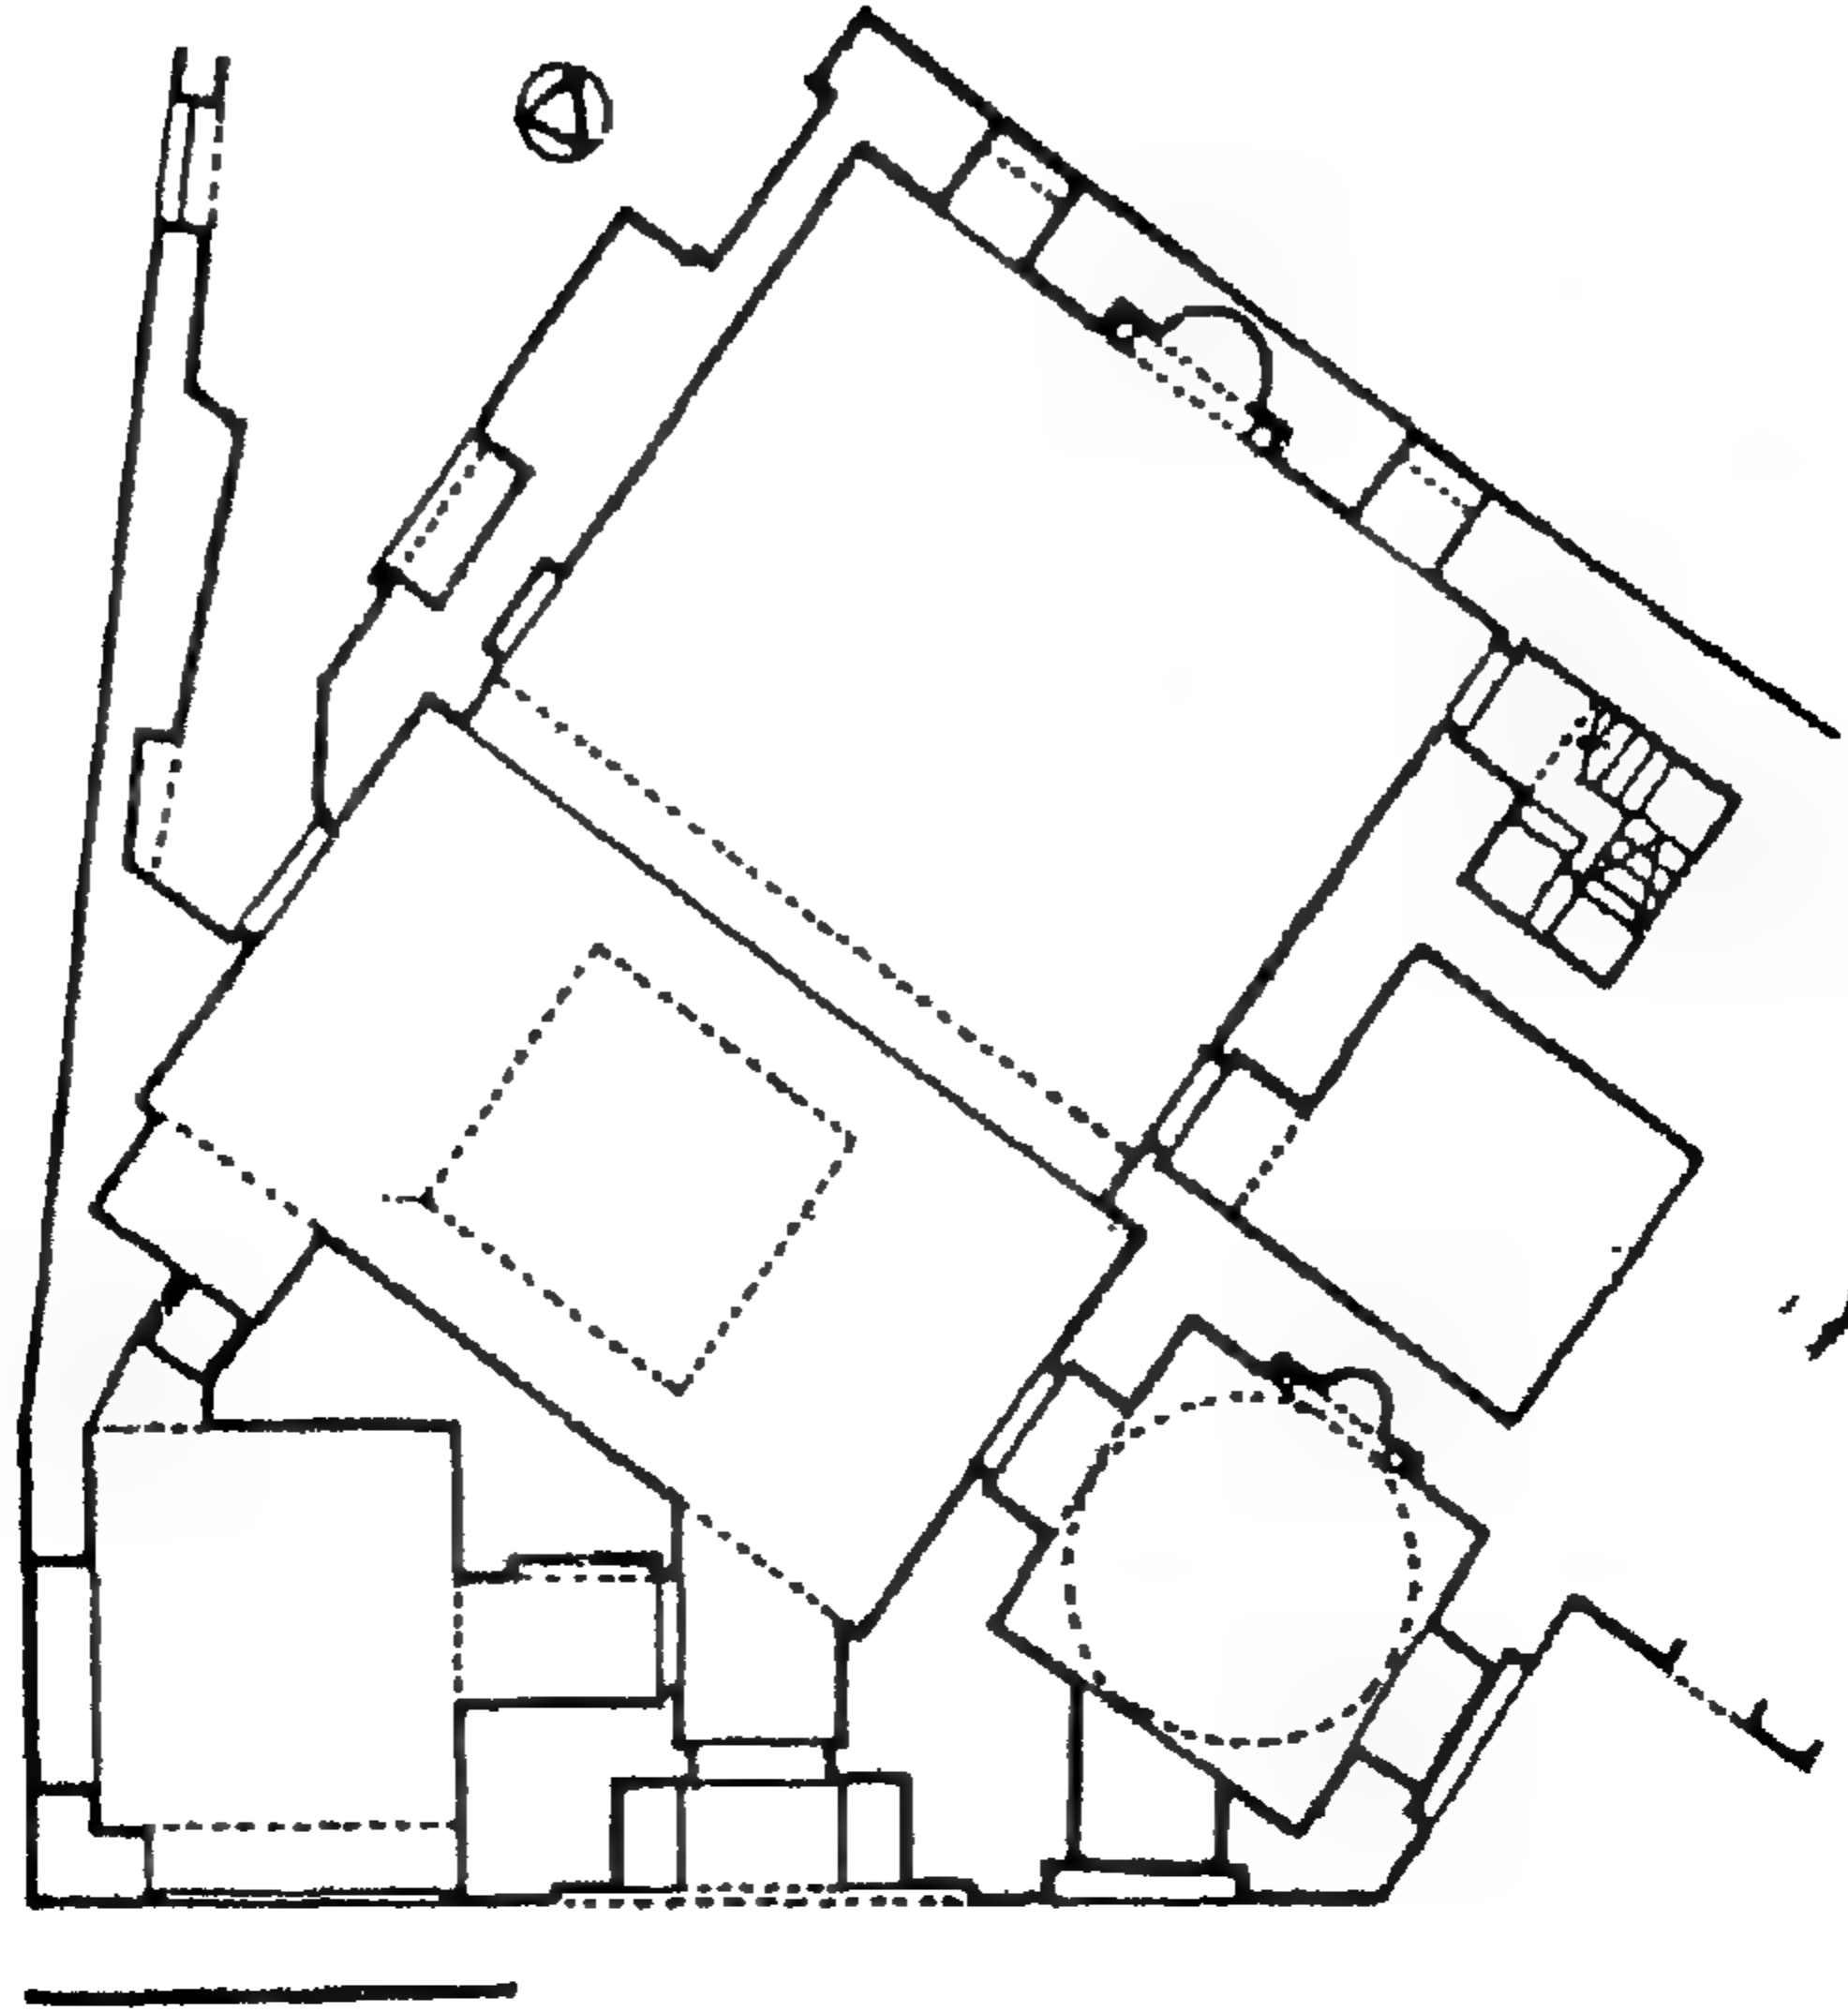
مسقط أفقي لجامع عابدي بك بمصر
